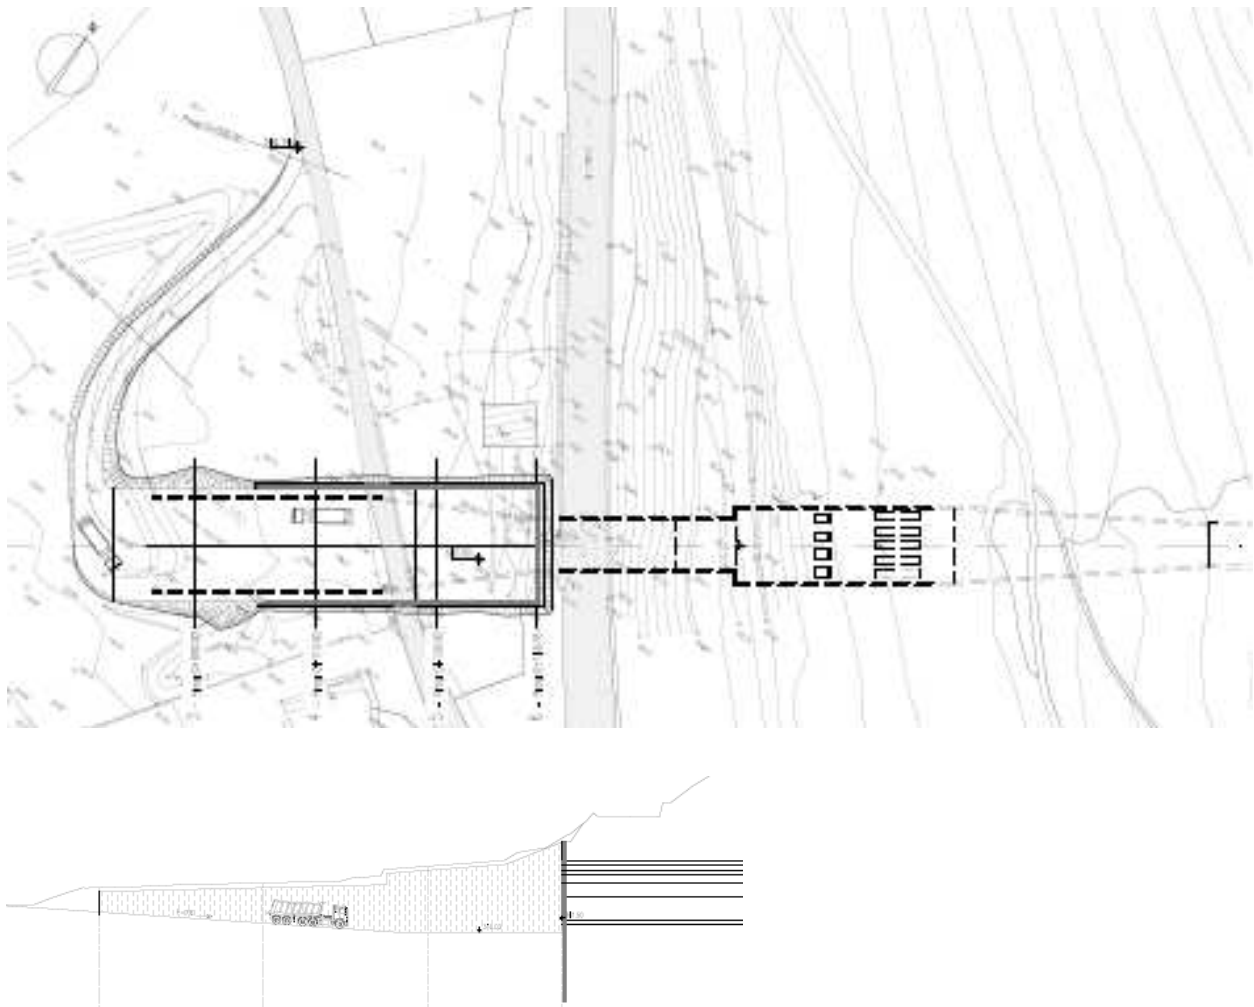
Planimetria e profilo dell'area cantiere di sbocco galleria.
